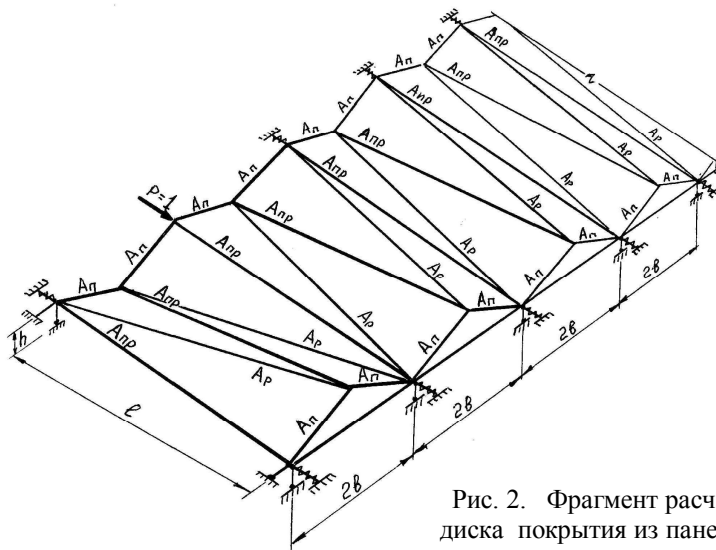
Фрагмент расчётной схемы диска покрытия из панелей-оболочек
